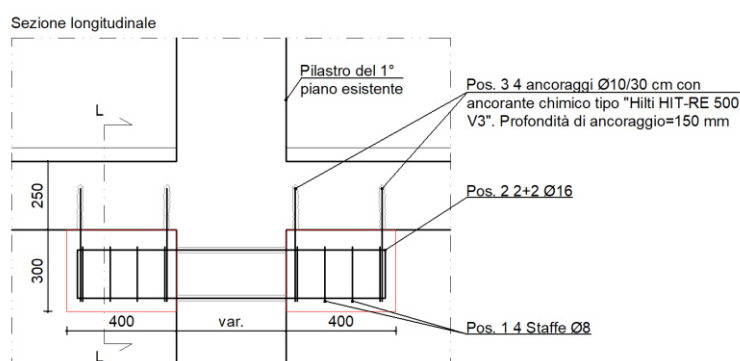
Dettaglio intervento di rinforzo delle travi al piano terra.
